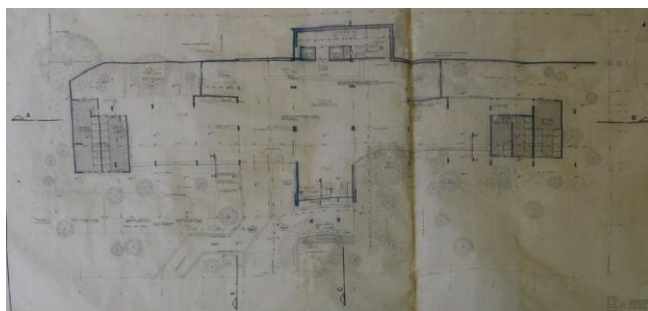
Planta Pav. Térreo RU, 1977. Fonte: Acervo SUMAI.
